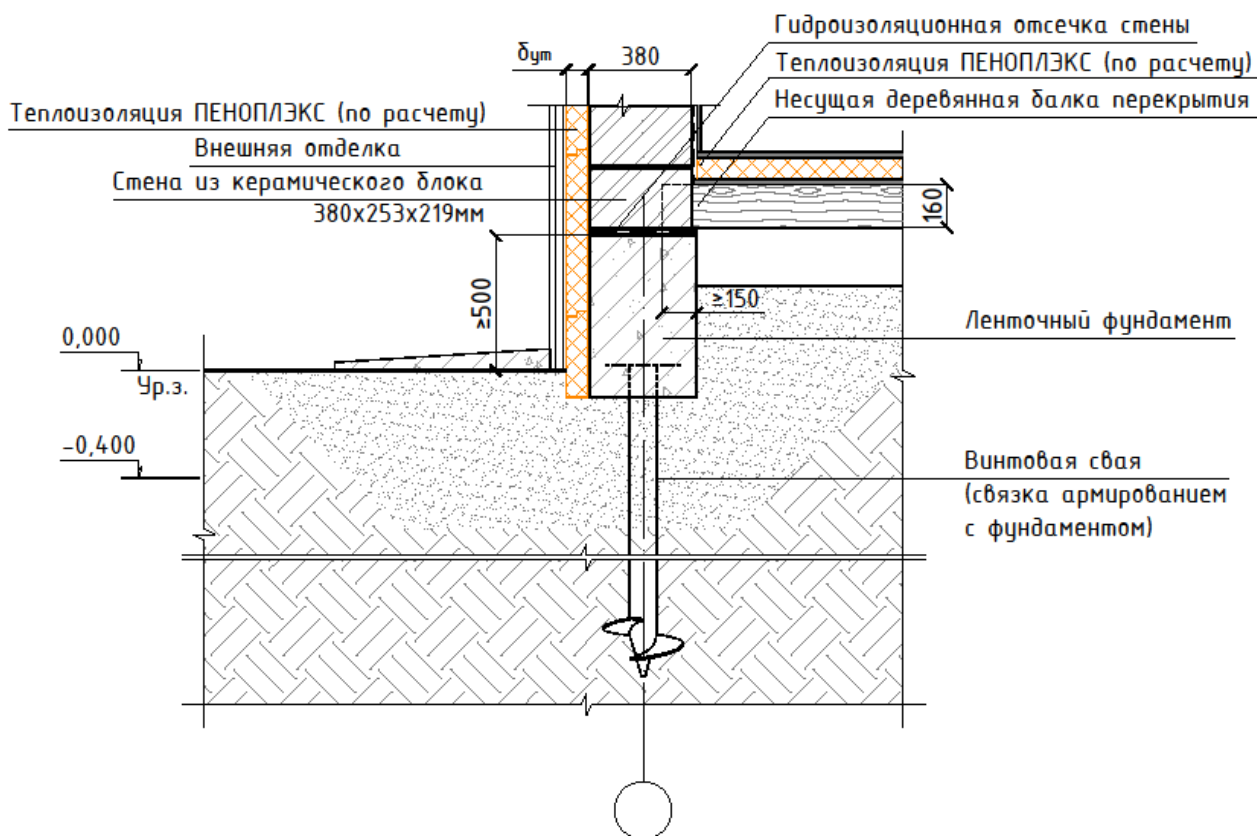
Схема сопряжения малозаглубленного ленточного фундамента на винтовых сваях и стены из керамических блоков.
